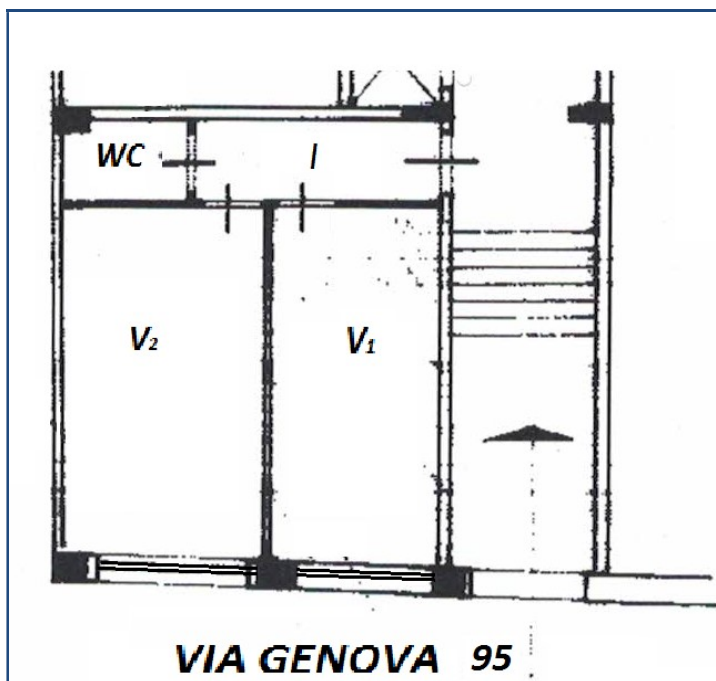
Rappresentazione planimetrica dell'abitazione al piano rialzato (disegno non in scala)
